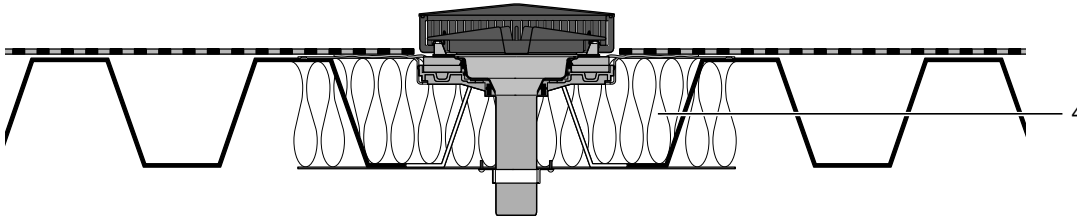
Dachaufbau Leichtbau mit Geberit Pluvia Dachwassereinlauf und Geberit Pluvia Dachdurchführung mit Brandschutz
